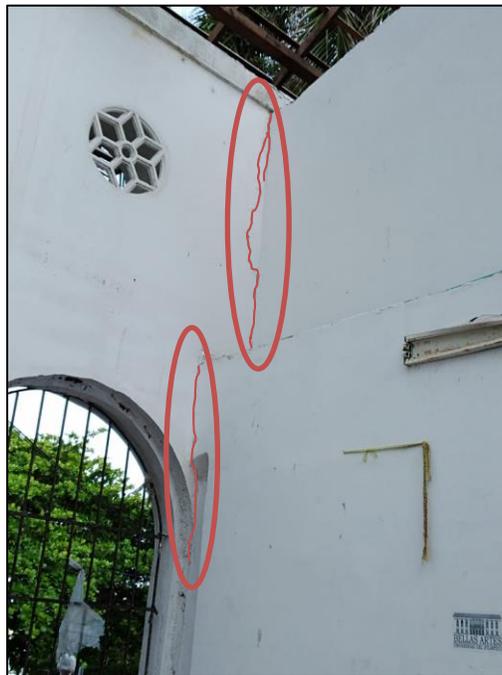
Muros fisurados del bloque B5 – Galería
